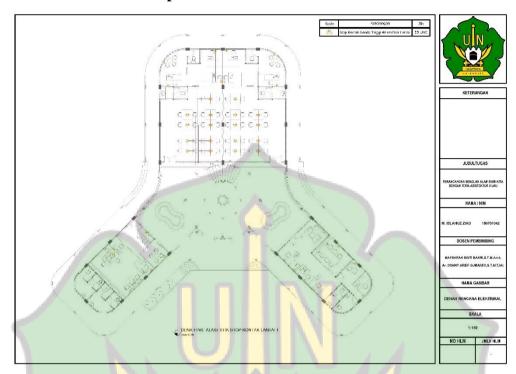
61 Denah instalasi titik lampu lantai 1 Sumber: Dokumen Pribadi
